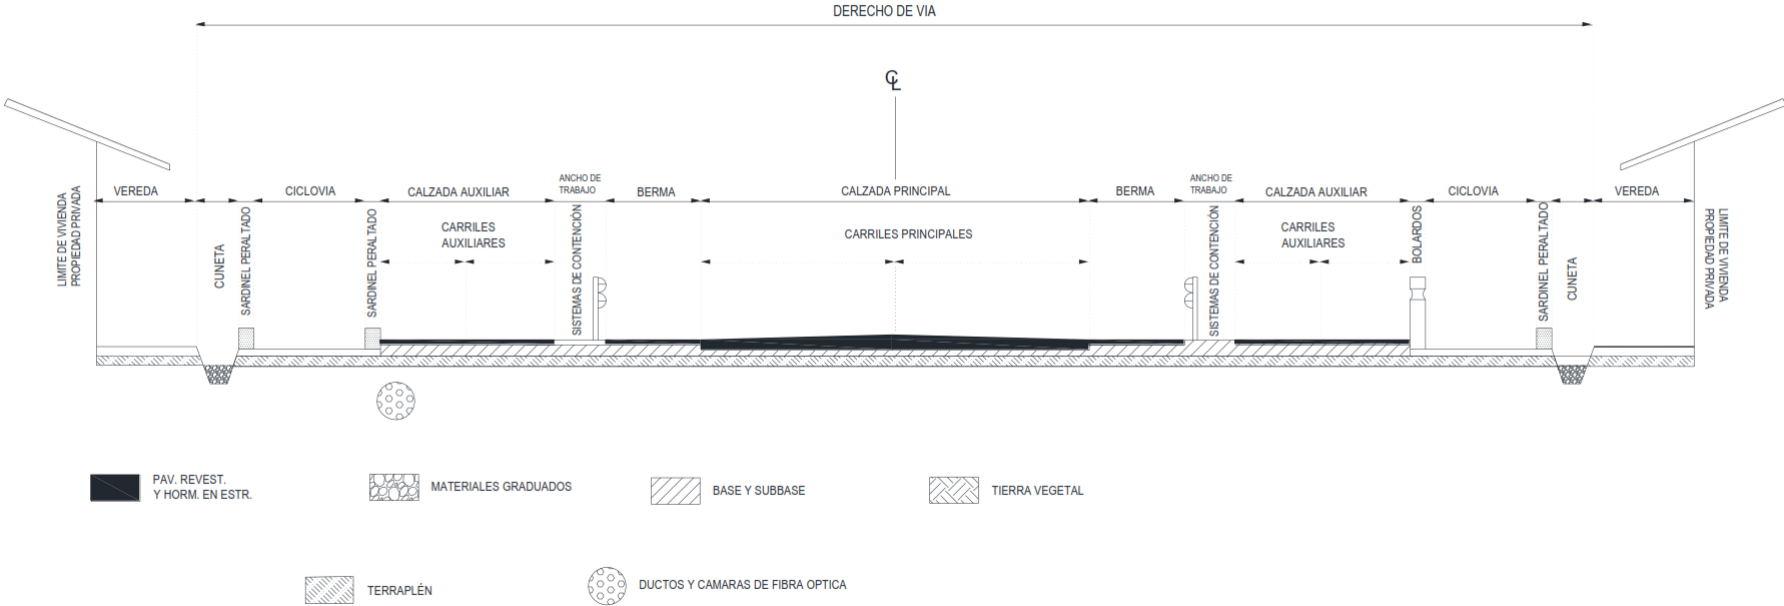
Sección transversal típica para carretera con calzadas separadas
